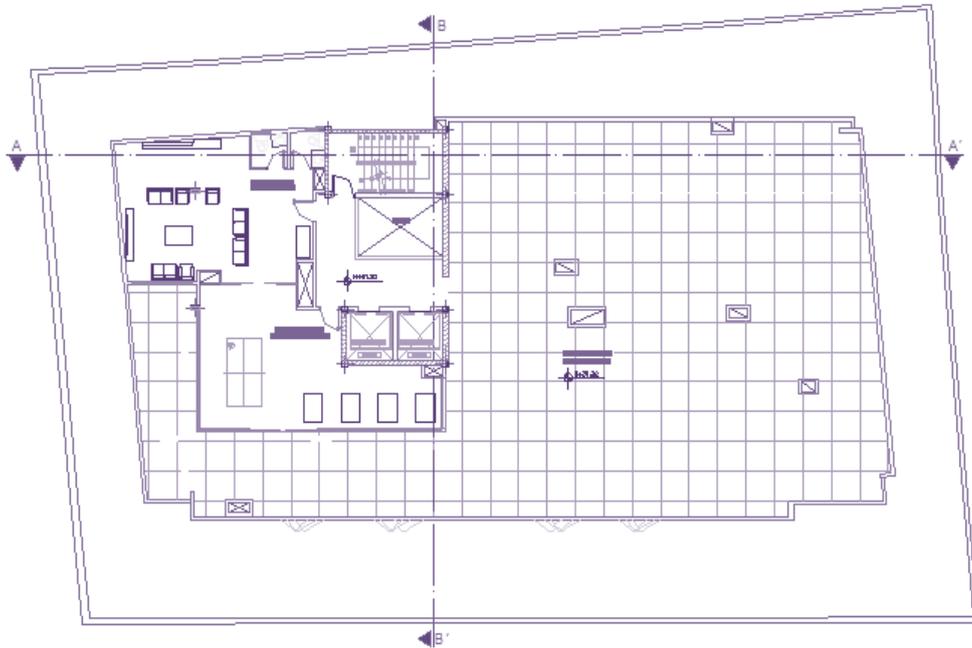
Plano Arquitectónico Referencial Planta Tipo 2
